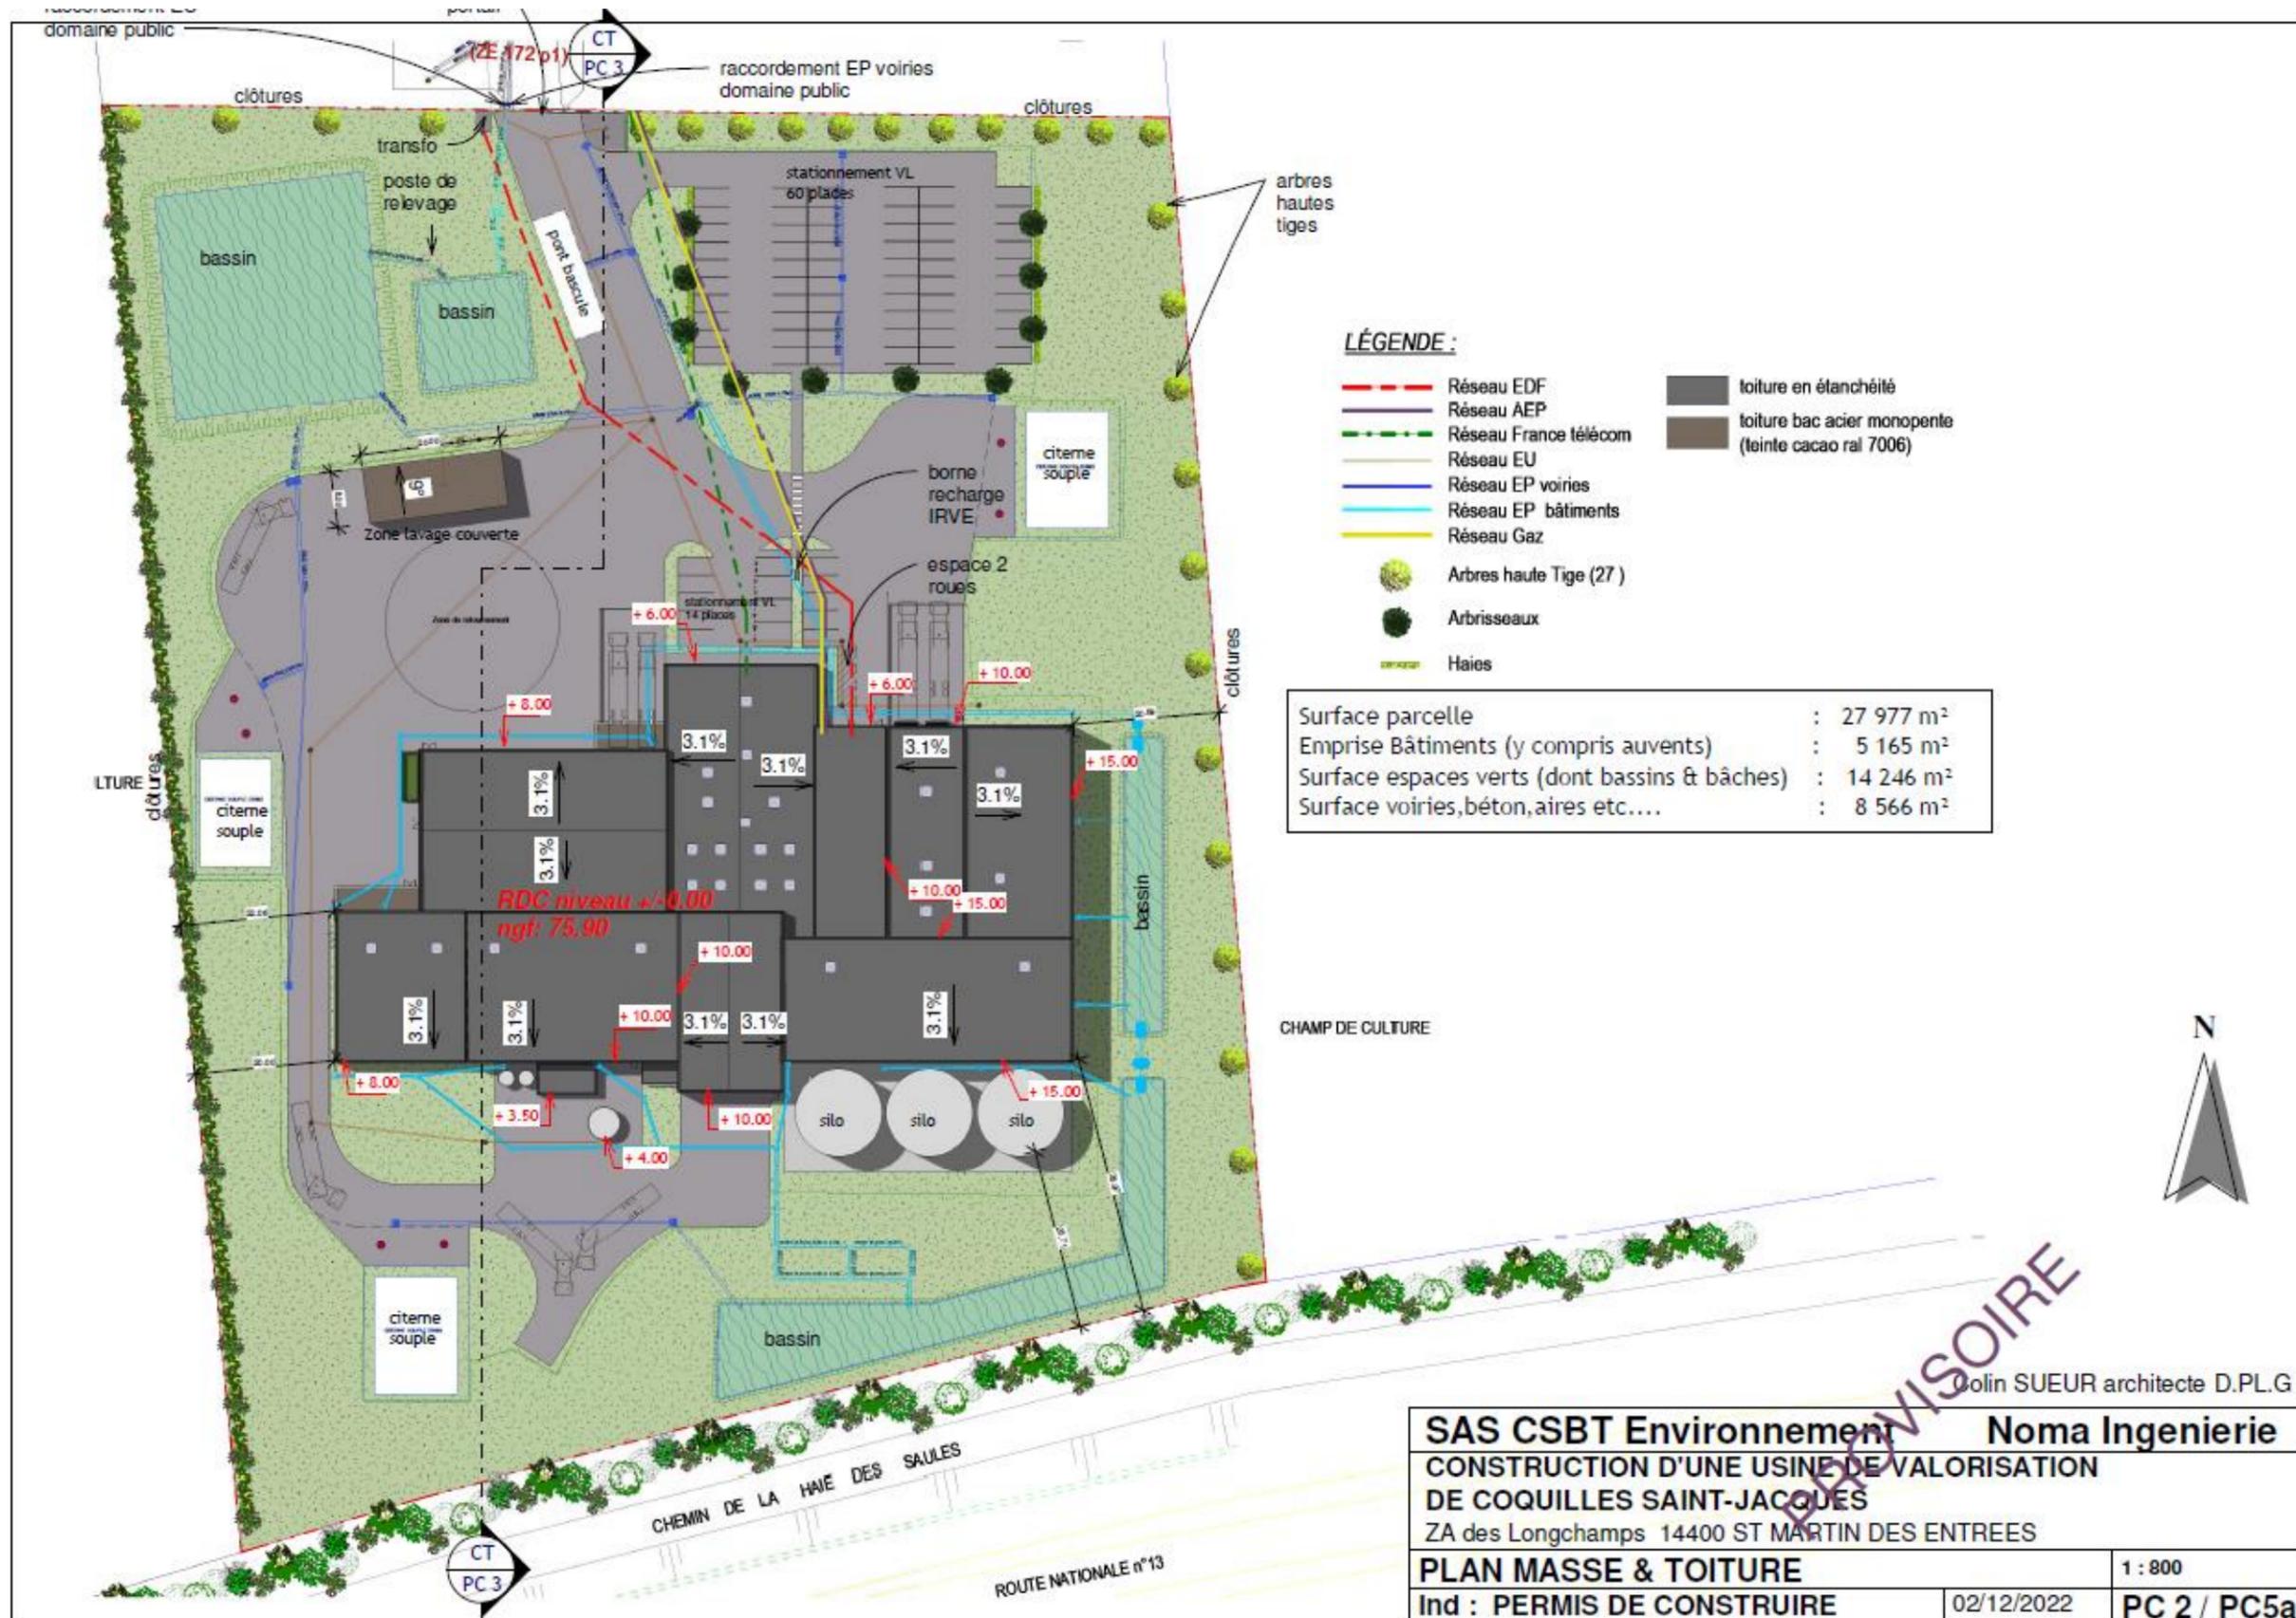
PLAN DE MASSE – EXTRAIT DE PLAN PC
